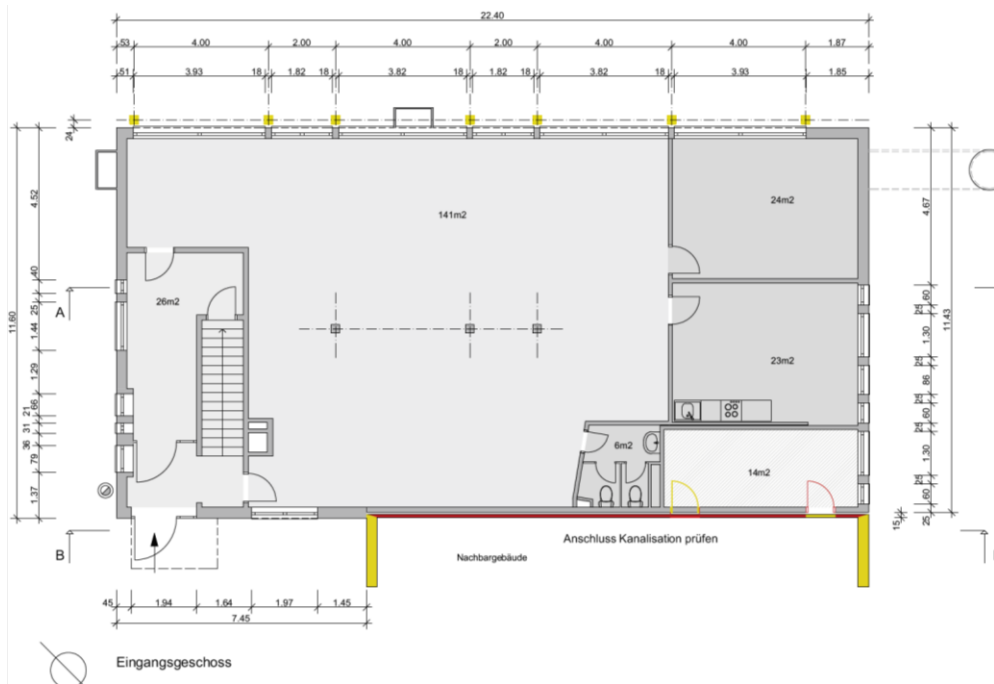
Grundriss mit Abbrüchen (gelb)
